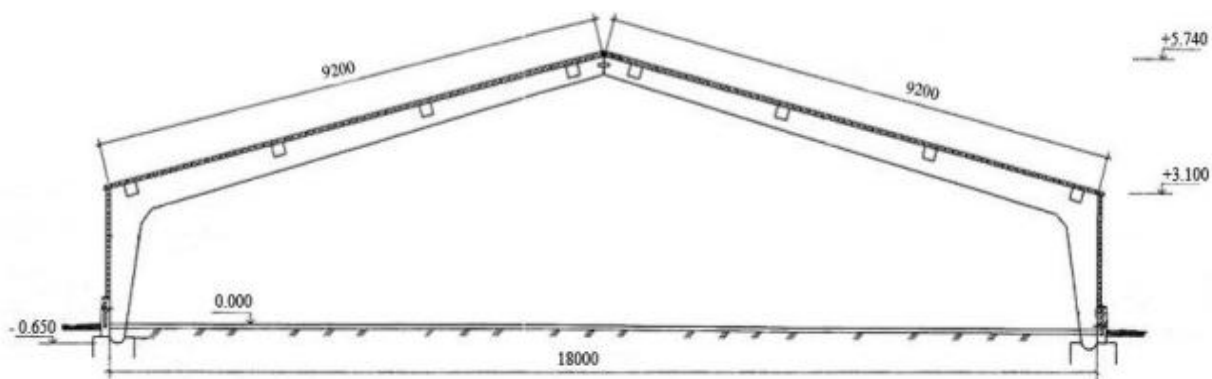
Графічна візуалізація конструкції залізобетонного каркаса будівлі в проектах БСБ
